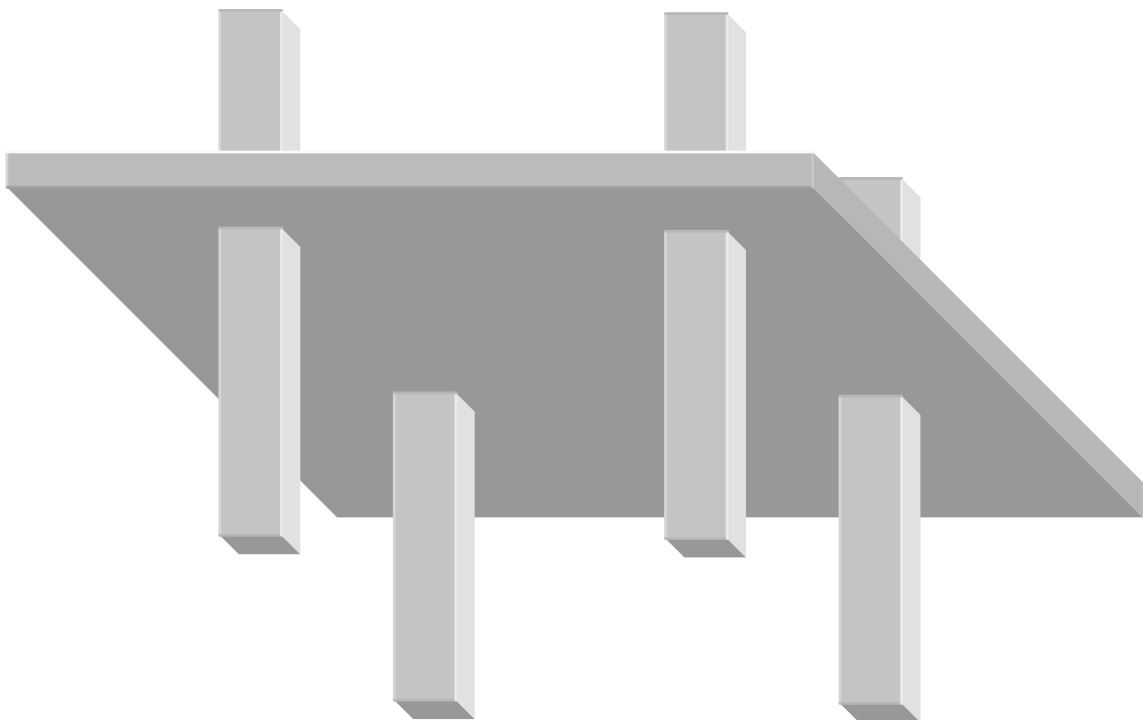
Sistema estrutural com laje plana (“flat plate”).
